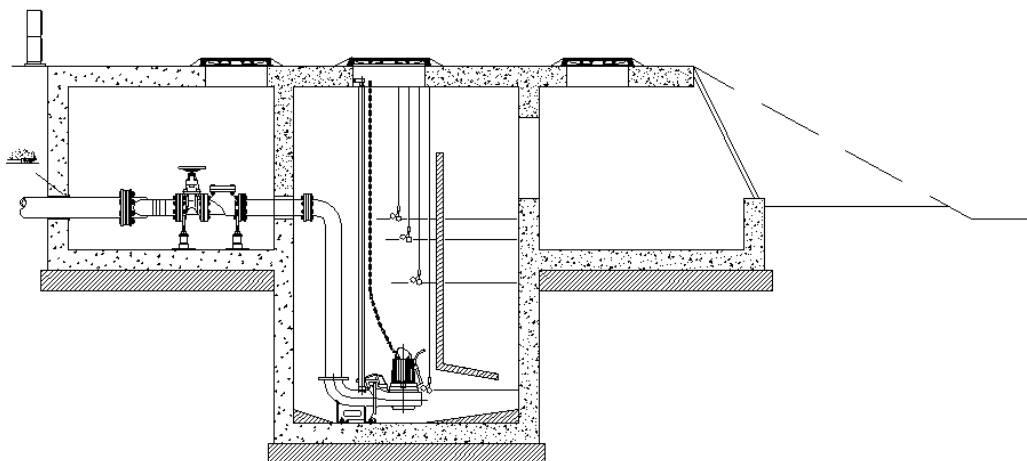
SEZIONE DELL'IMPIANTO DI SOLLEVAMENTO
